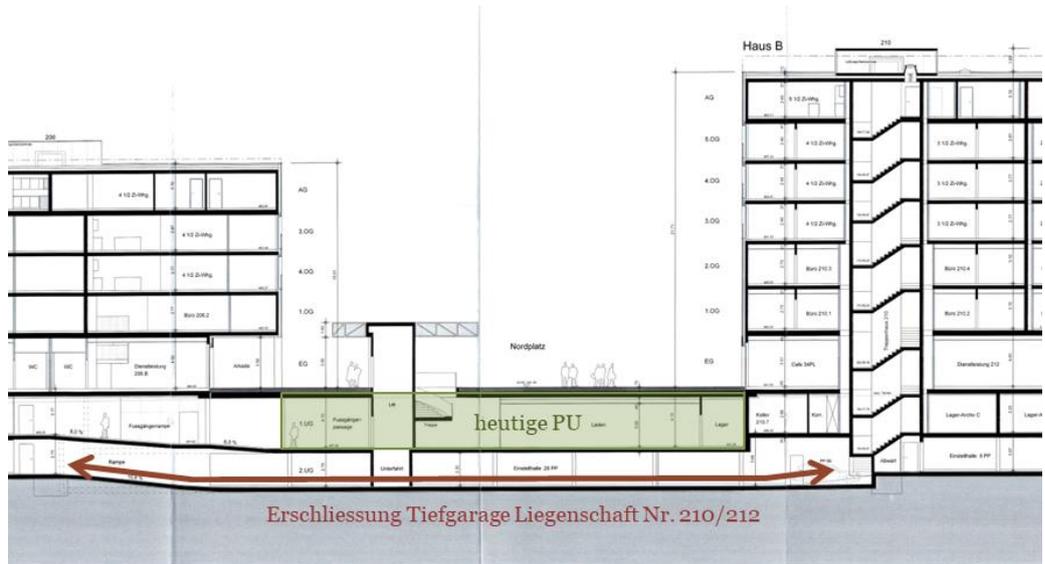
Schnitt und Grundriss Bereich Nordplatz
